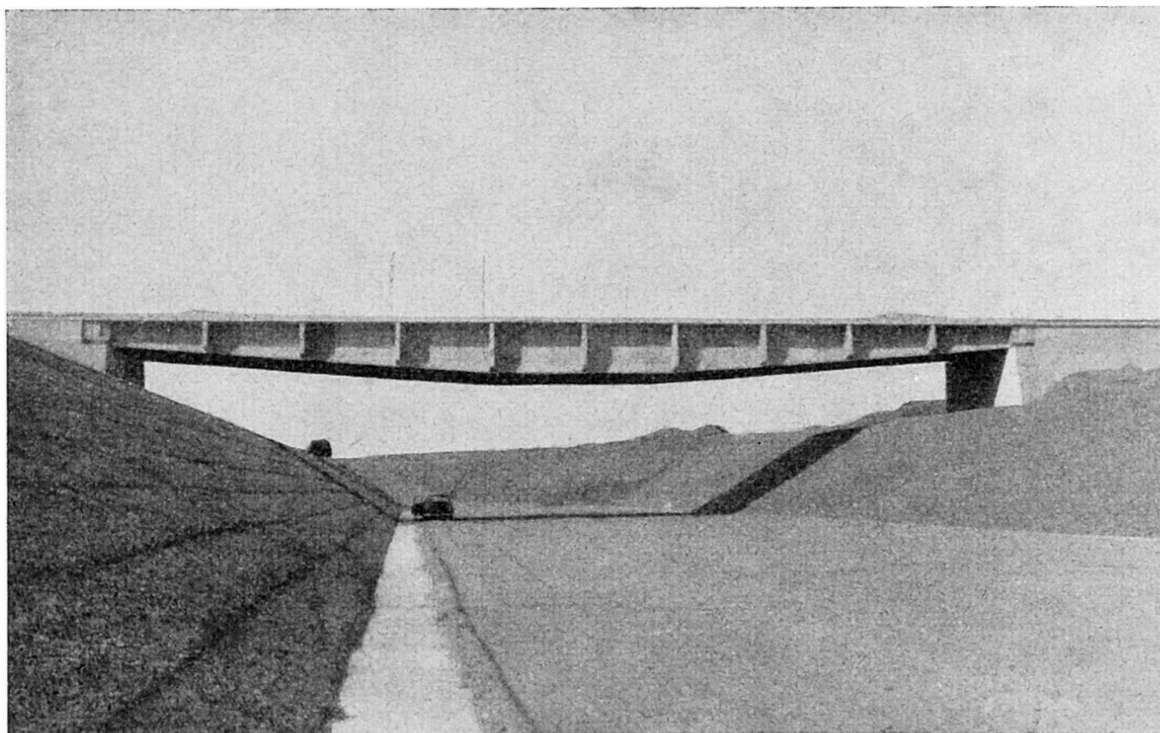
Pont du Canal del Bajo Guadalquivir.
